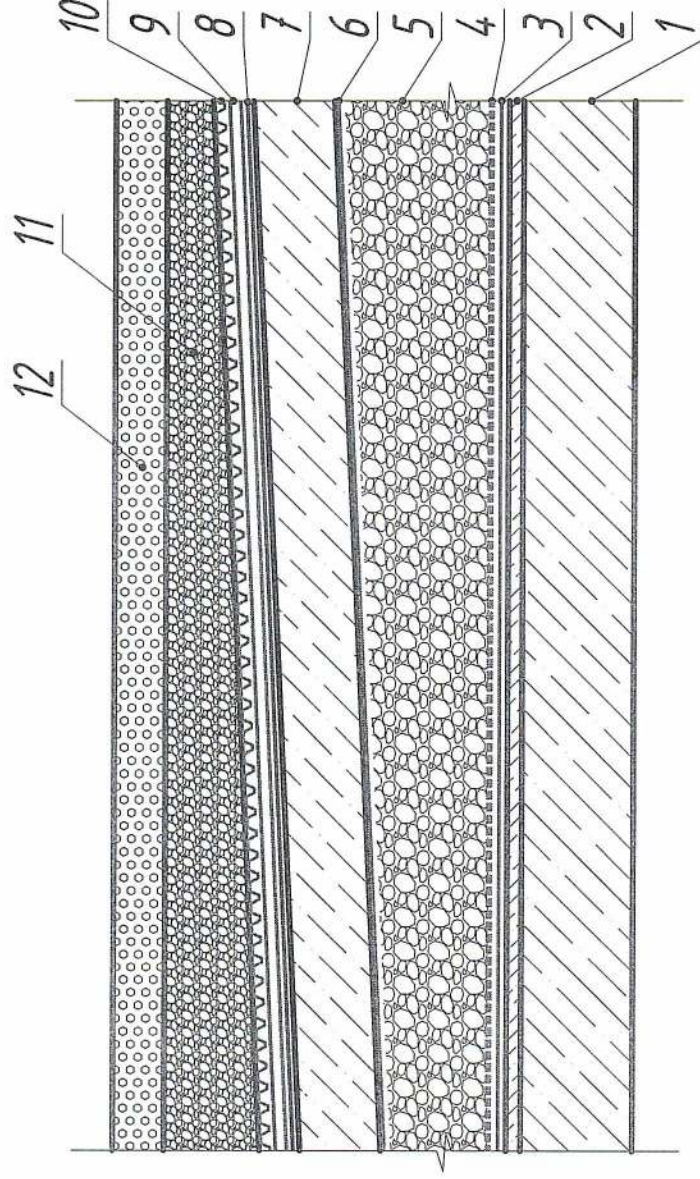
Принципиальная схема конструктивного исполнения настила бесчердачного покрытия выполняемого по железобетонному основанию (эксплуатируемая кровля под спортивное покрытие)
